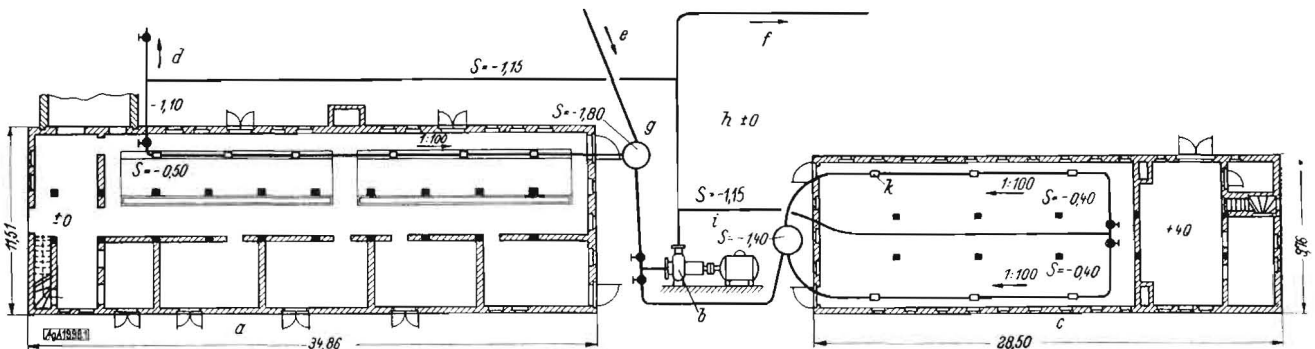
Grundriß für eine Stallmist-Schwemmanlage
